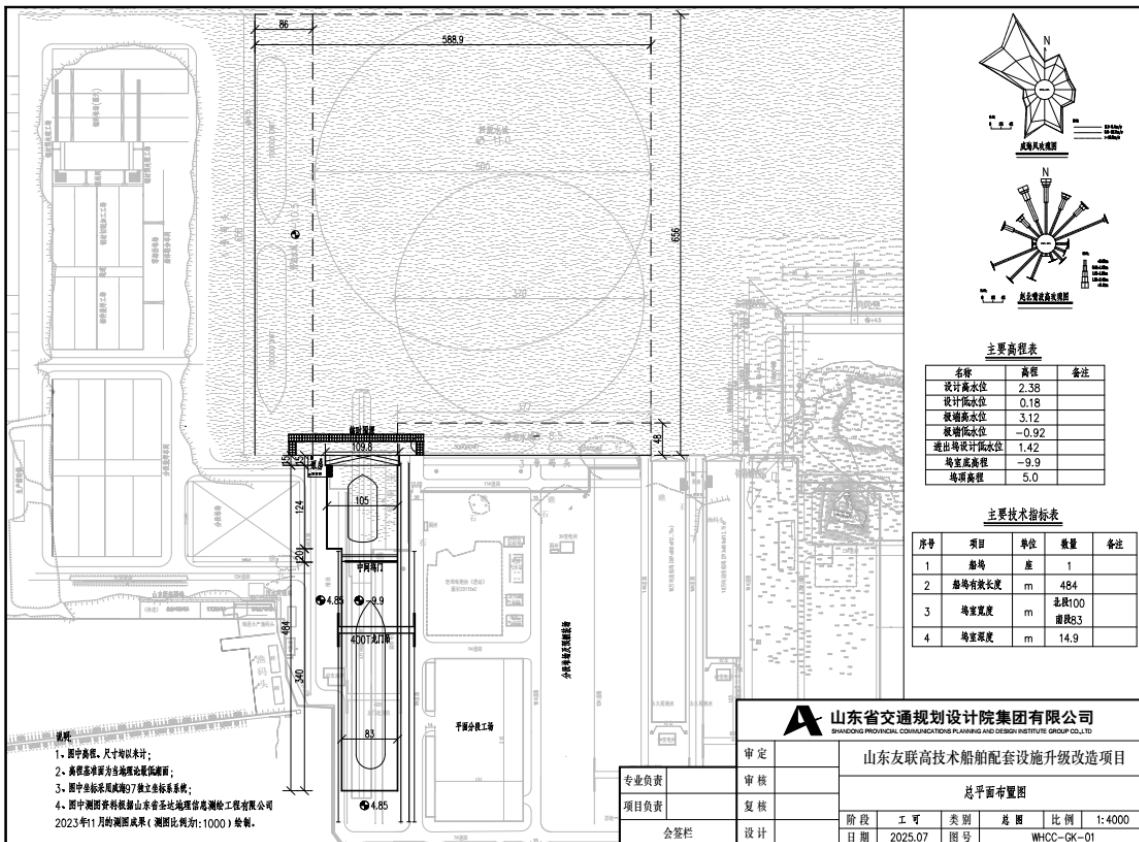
大型高端海工装备配套升级改造项目整体平面布置图
